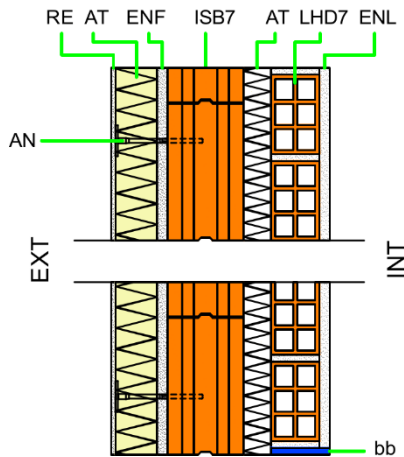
Fachada con sistema ISOBLOCK®, fachada ventilada exterior y trasdosado cerámico.
